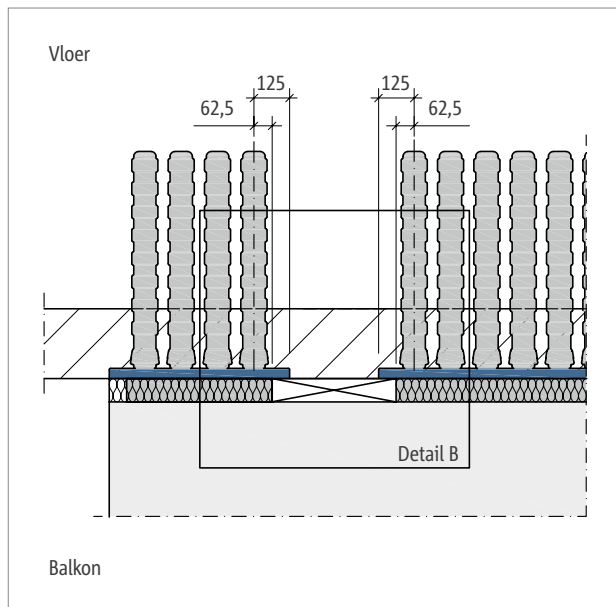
Schöck Isokorf® T type Q-E: detail A, juist door naleving van de rastermaat en de voorgeschreven afstanden
